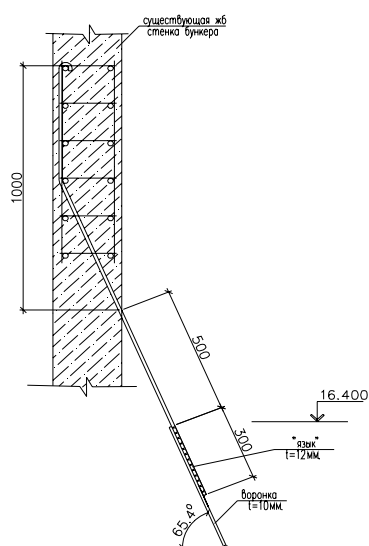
Схема узла крепление воронки к стенке силоса с помощью листовых накладок (языков).
